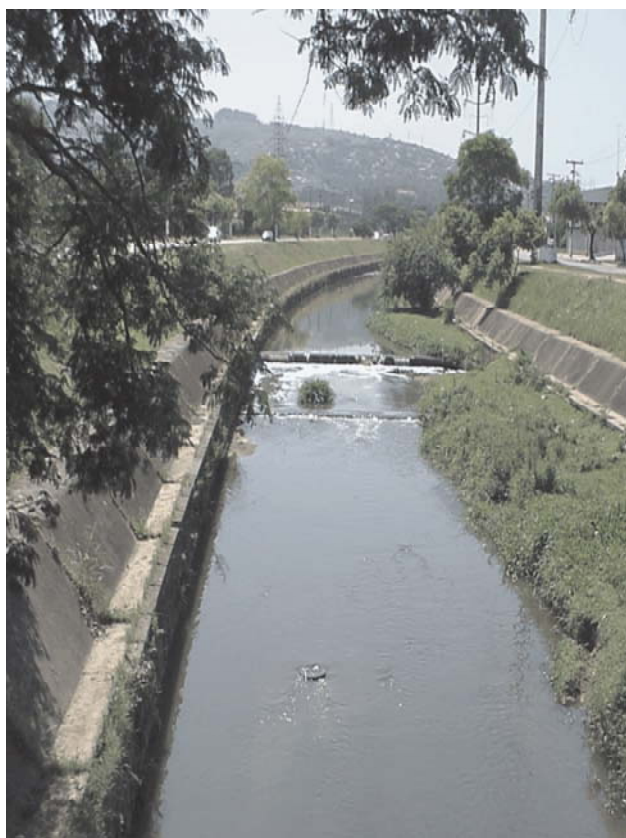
Obstruções ao escoamento em canais (Porto Alegre)
